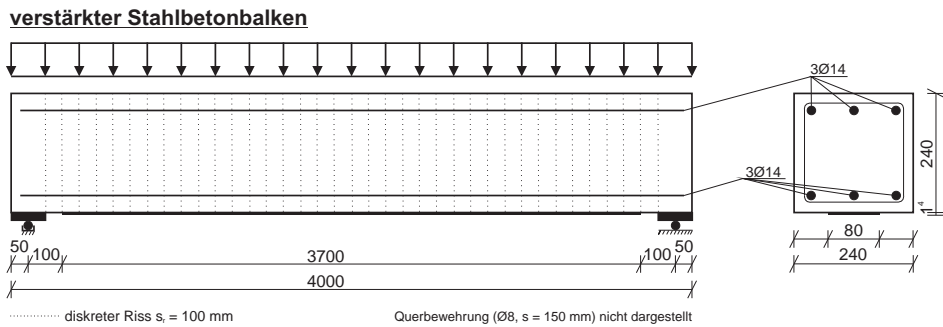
Modellierter verstärkter Stahlbetonbalken [83]
